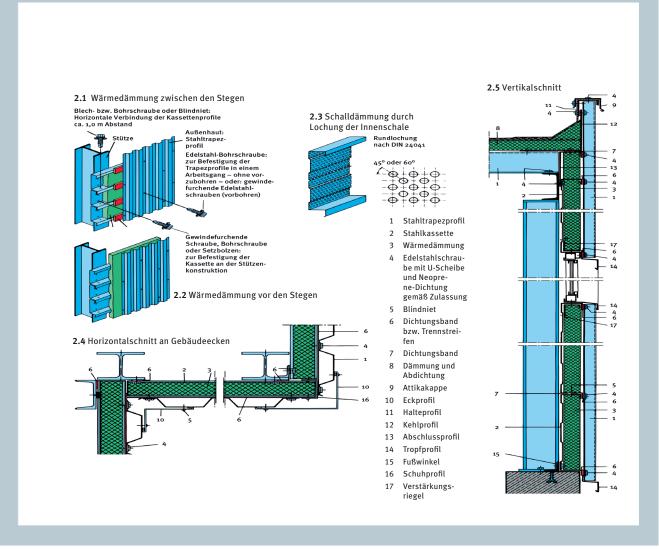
Stahl-Kassettenwand: konstruktive Details zum Wärme- und Schallschutz
